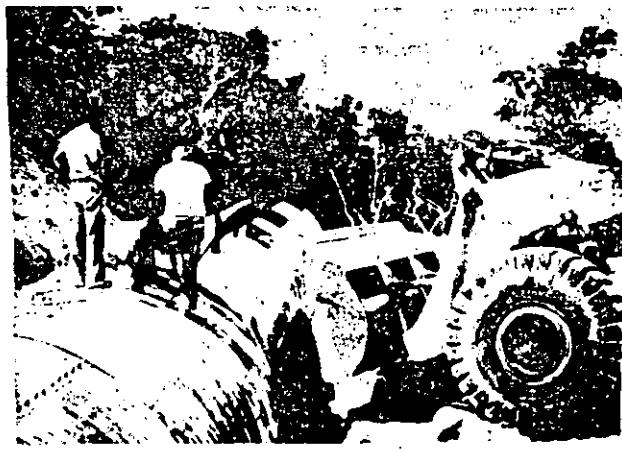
Vista de la alcantarilla flexible del pedraplén "La Plazuela".
